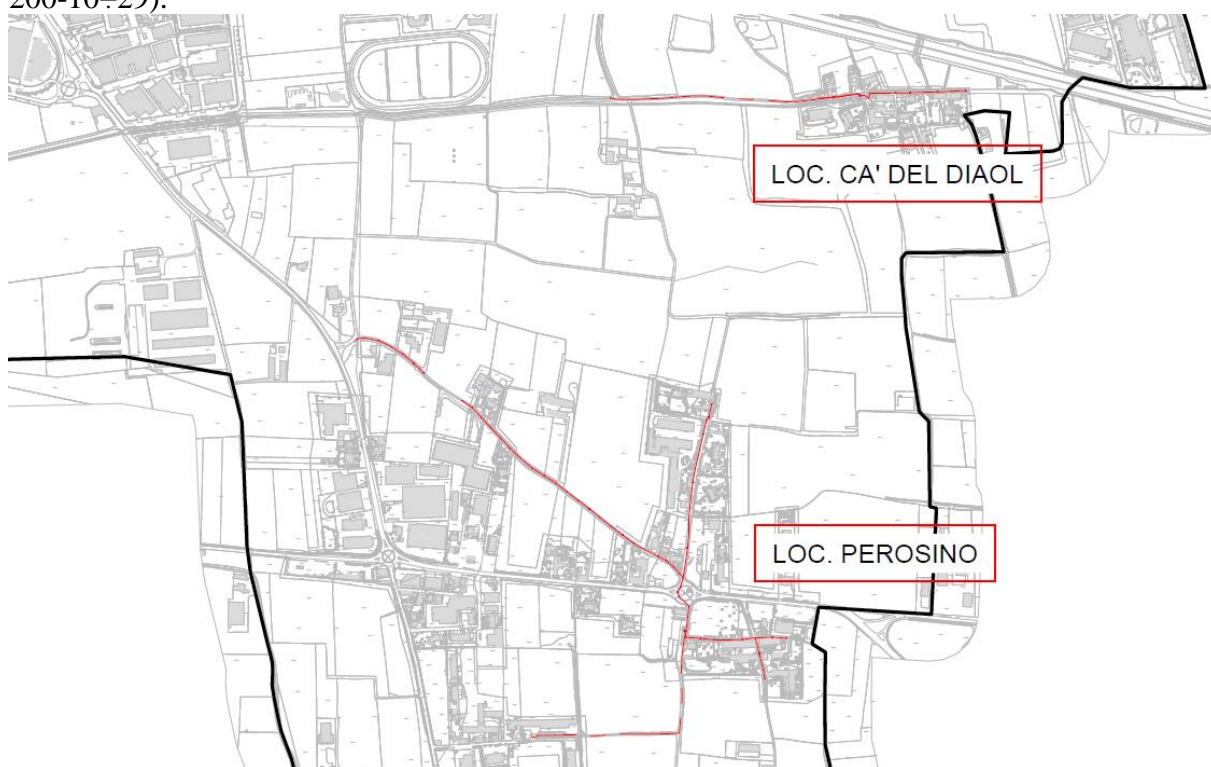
Stralcio planimetrico delle aree interessate dalle opere in progetto
